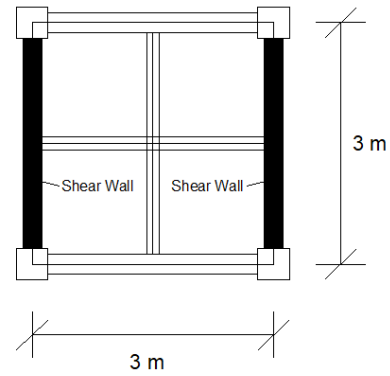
Denah Tampak Lantai 1 (Tipe 2)
